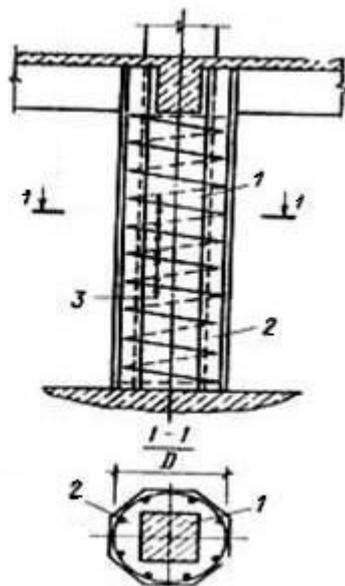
Усиление колонны обоймой со спиральной арматурой
